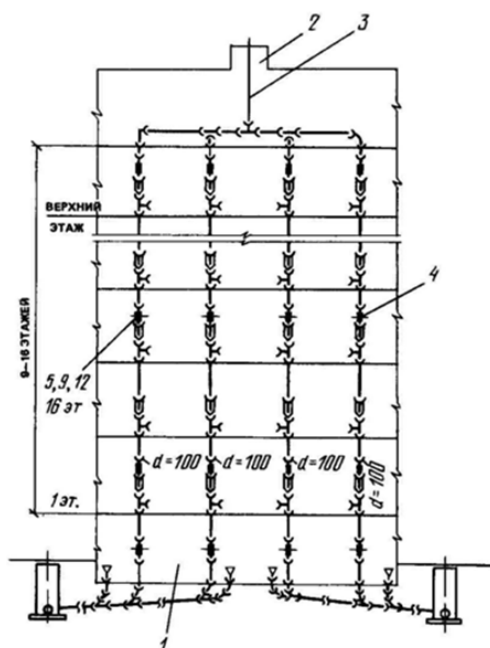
Схема объединения вентиляционных канализационных стояков в жилом здании: 1 – техническое подполье; 2 – вентиляционная шахта теплого чердака; 3 – общий вытяжной стояк; 4 – канализационные стояки
